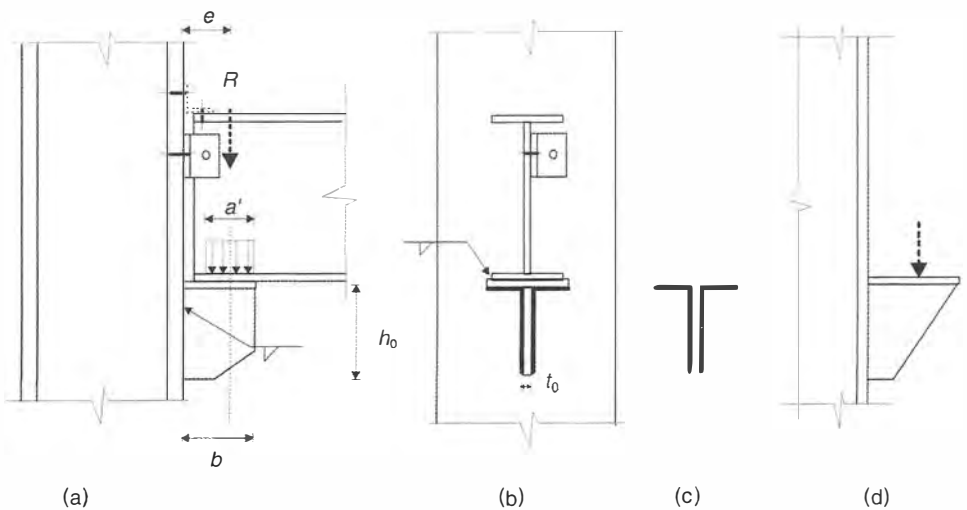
Apoio em consolo soldado ao pilar: (a) vista lateral; (b) vista frontal; (c) seção de filetes de solda; (d) consolo enrijecido com bordo livre não paralelo à direção da carga.
